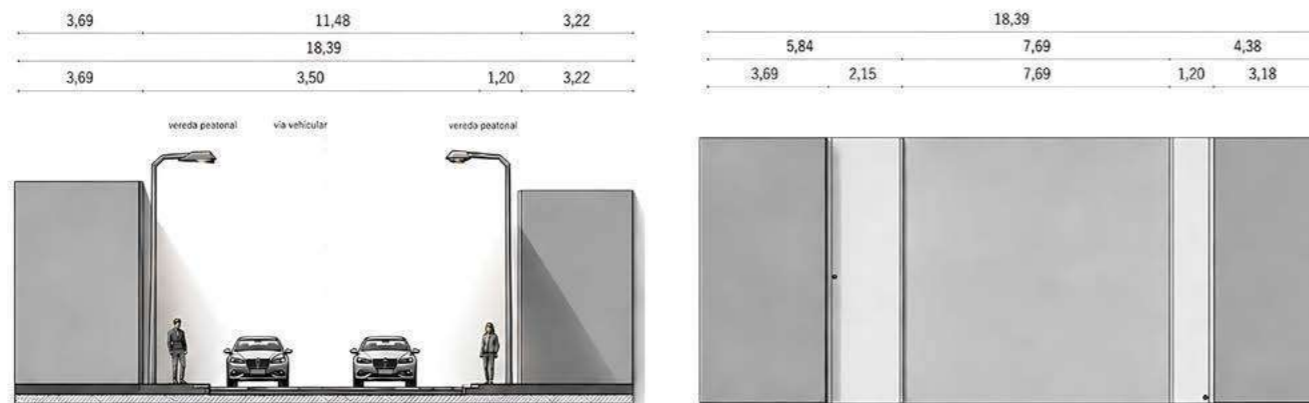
Estado actual de la sección y planta en la calle Rafael María Arízaga. Elaboración propia.
